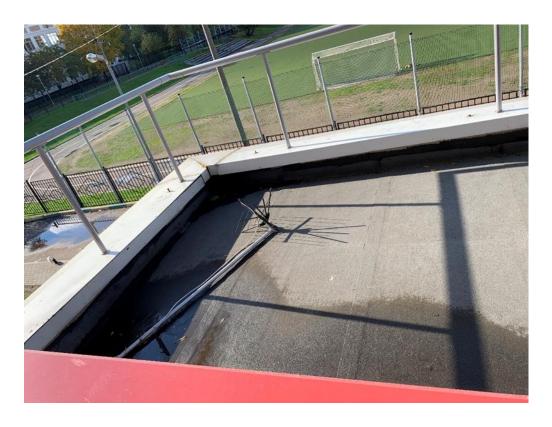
Намокание гидроизоляционного слоя кровли балкона, коррозия элементов парапета
